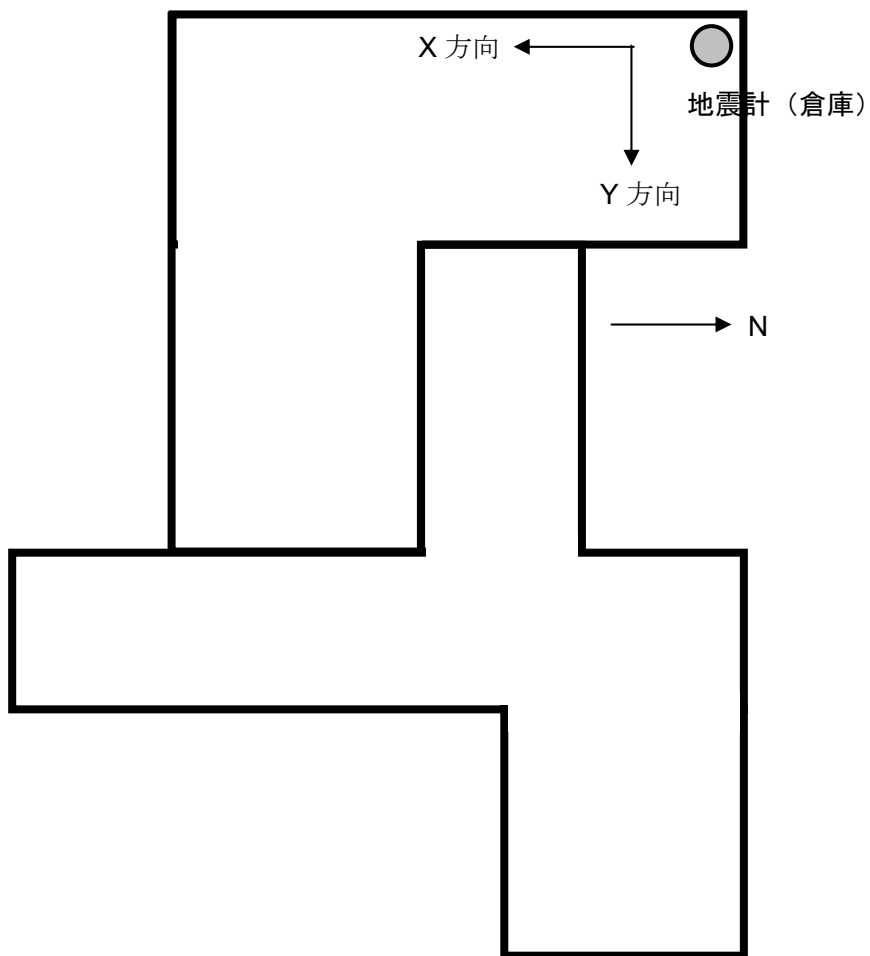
1 階平面図と地震計設置位置 (● 印)
